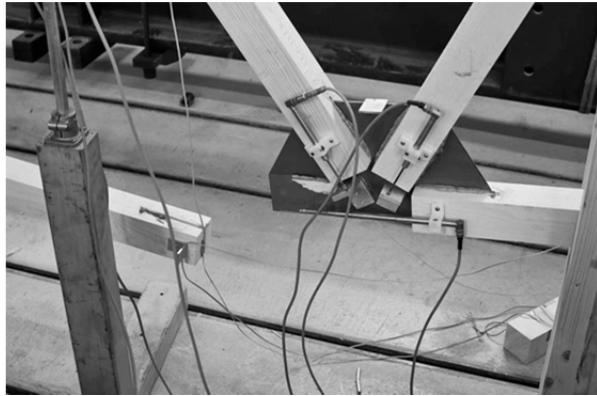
Fachwerk mit eingeklebtem Stahlblech [2]
